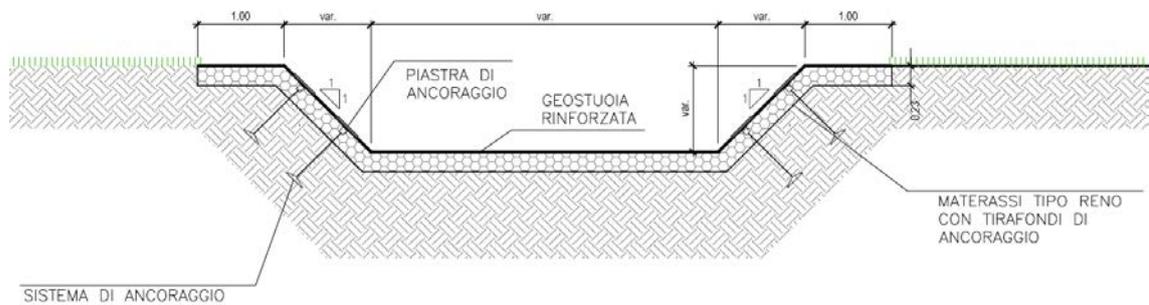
Sezione tipo trasversale Scolo Sereghetta
